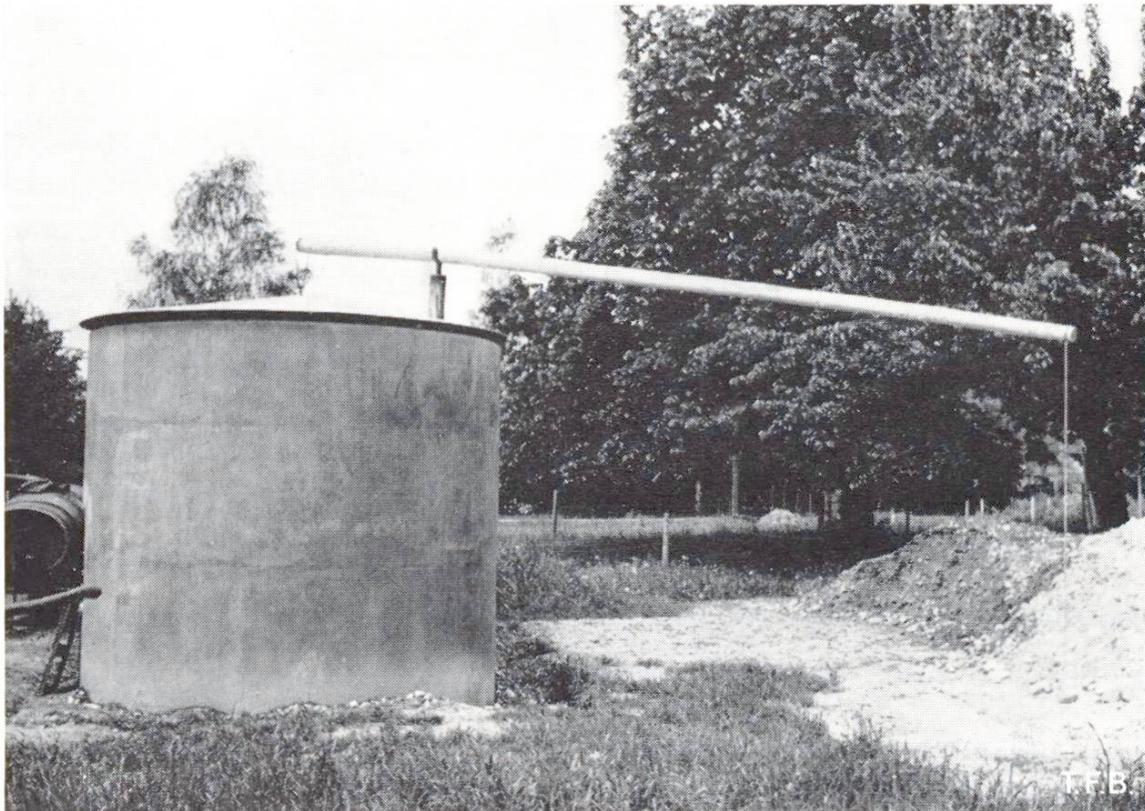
Halbhochsilo rund mit Tauchdeckel als Bedachung
